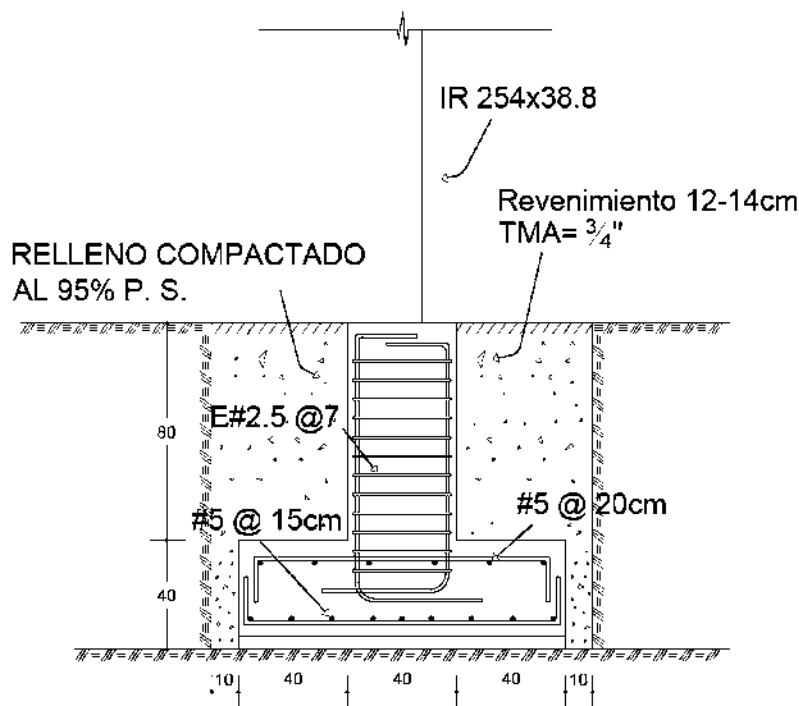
(e) Vista en alzado de la zapata, en dirección transversal de la cubierta,
